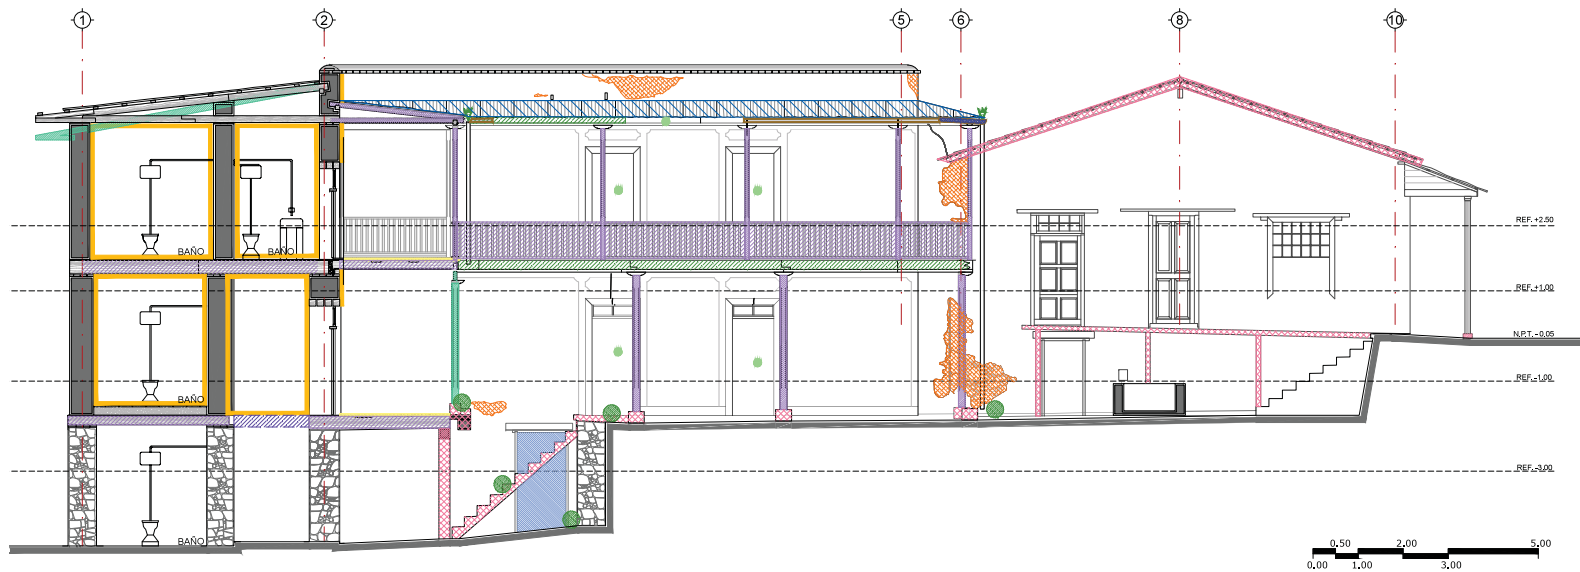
Plano de deterioros. Corte longitudinal del Hotel del Jardín
